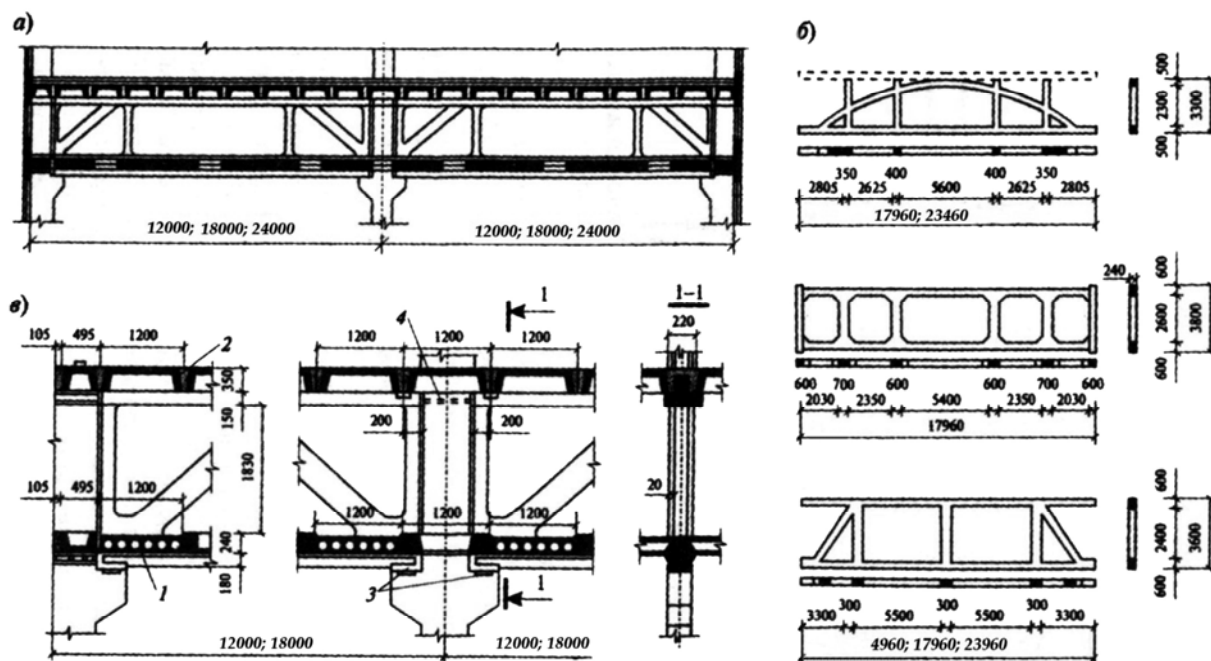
Конструкции технических этажей из железобетонных ригелей-ферм:
